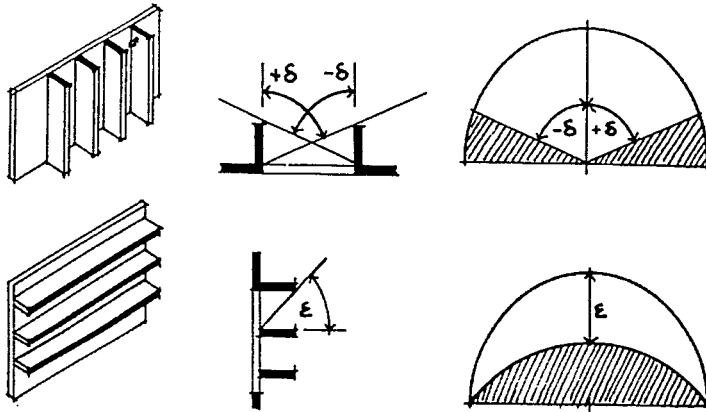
dispositivos de apuntalamiento vertical (arriba) y horizontal (abajo).
